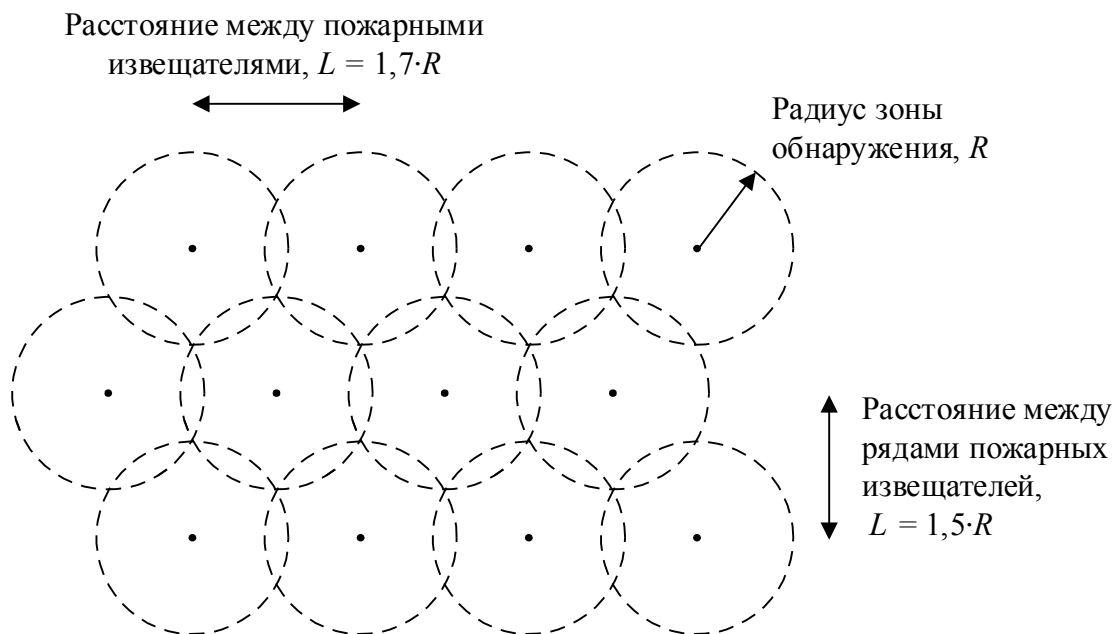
Схема размещения дымовых или тепловых извещателей по "треугольной решетке"
